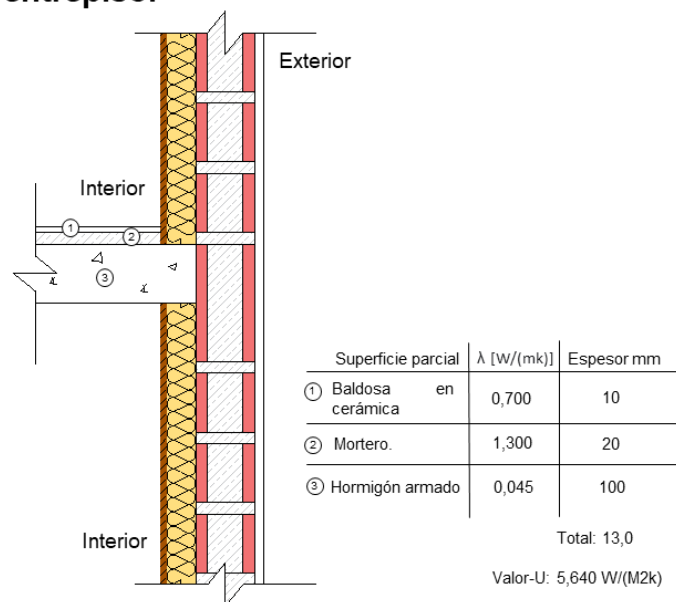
Detalle de solución constructiva para losa de entrepiso. Fuente: elaboración propia.
